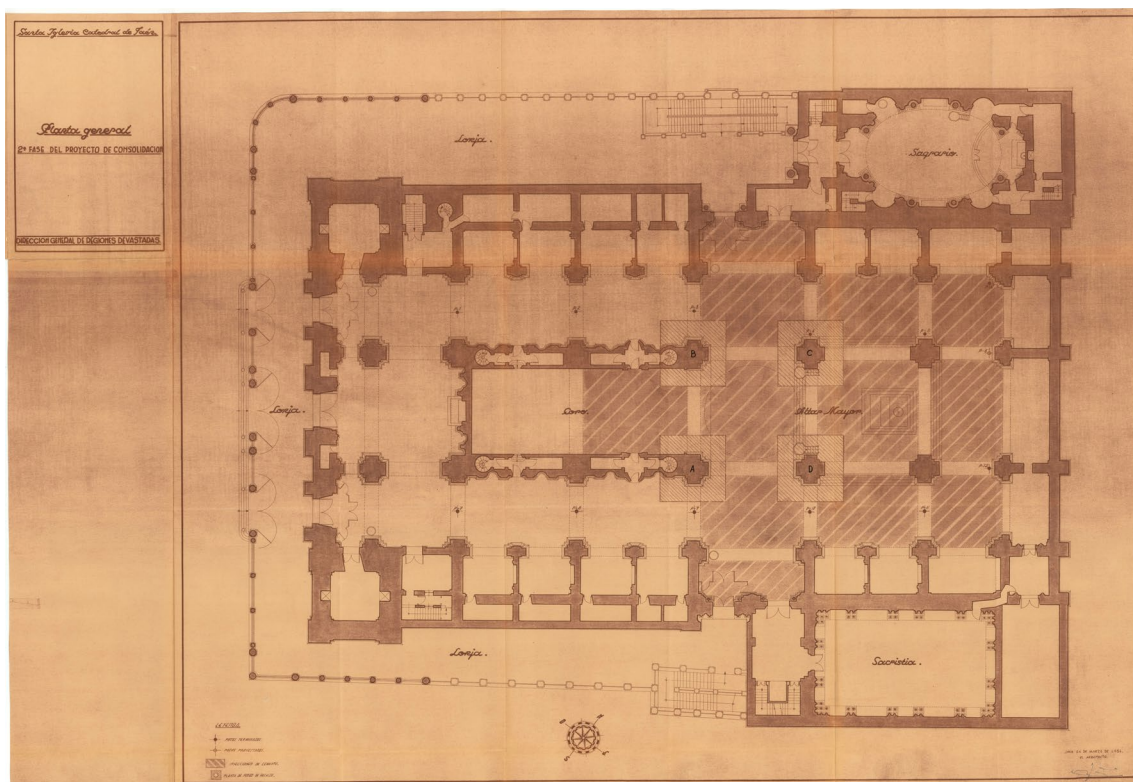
Ramón Pajares Pardo. Santa Iglesia Catedral de Jaén. Planta general – Segunda fase (1954).
